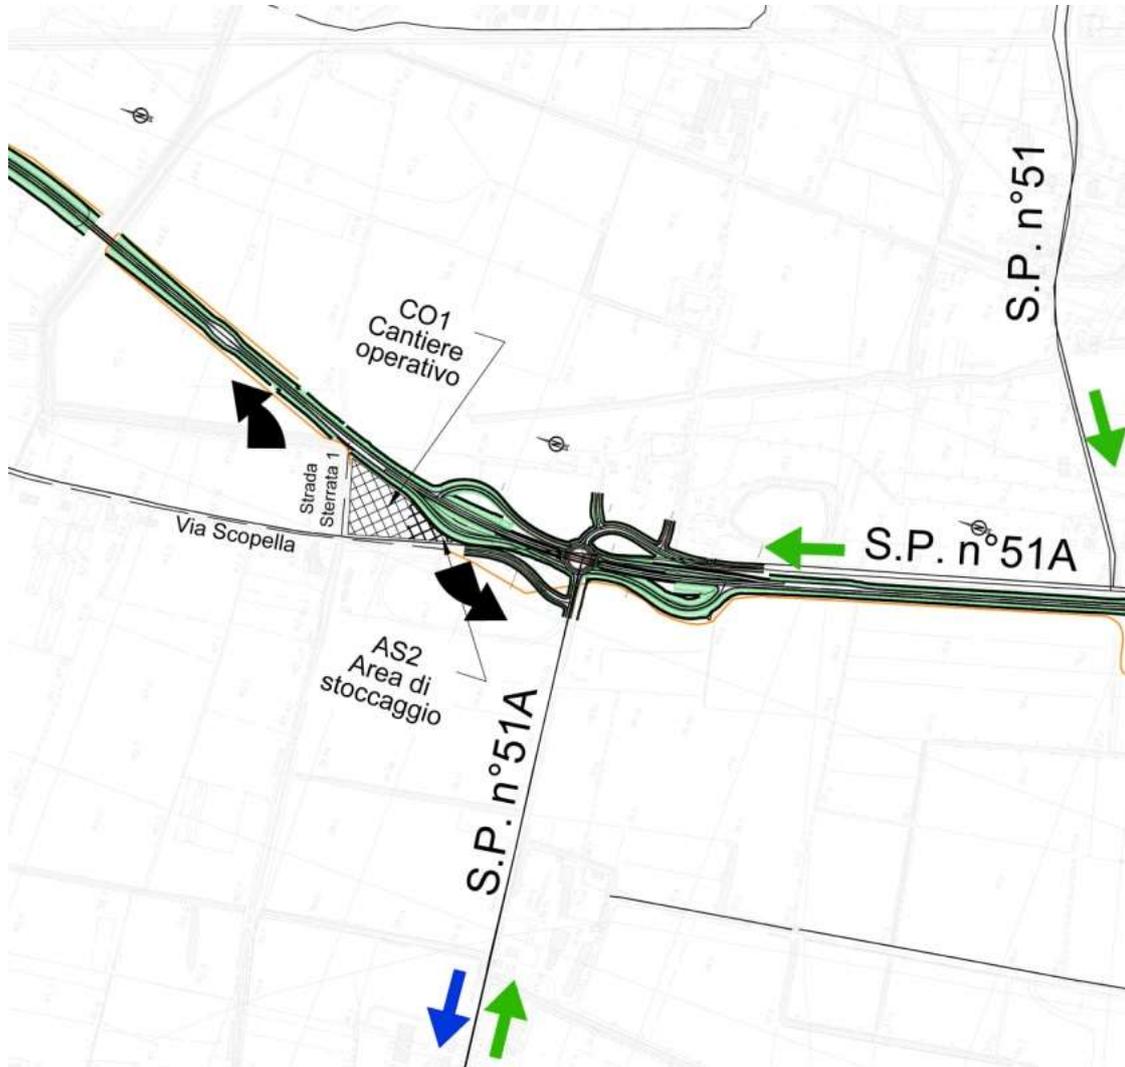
Stralcio 21-003_T00CA00CANPL01_A - Planimetria aree e viabilità di cantiere
